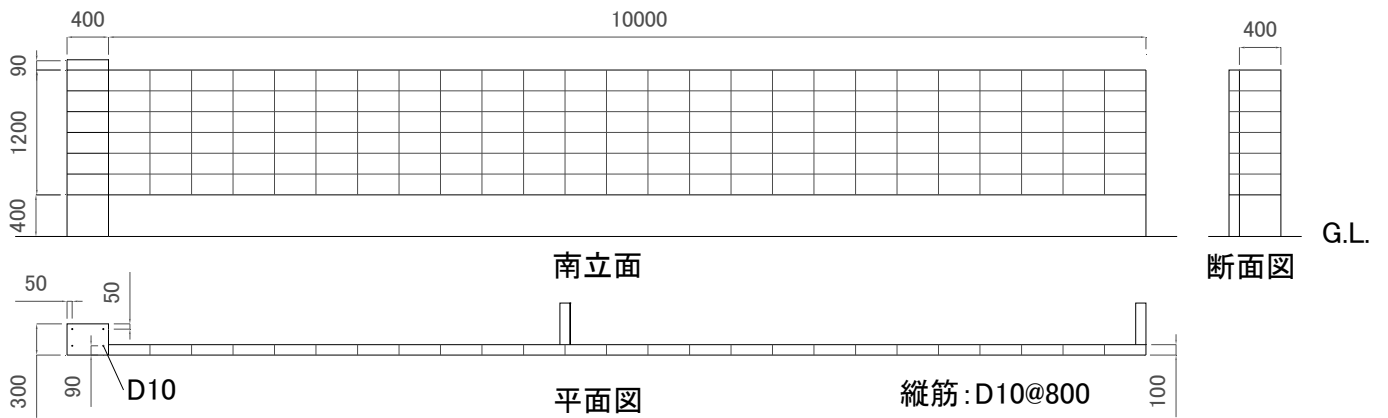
CB 塀の立面図・平面図 (単位: mm)
